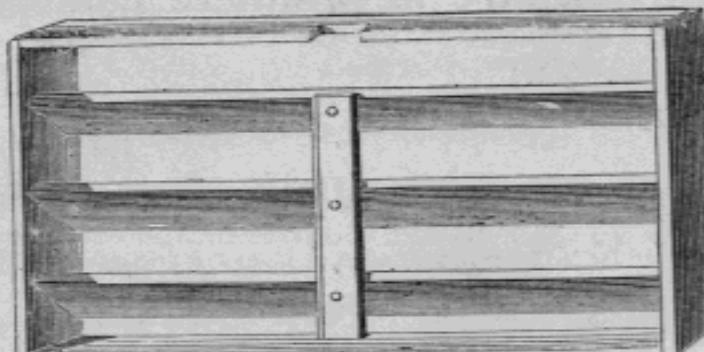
Persienne en bois de M. E. Damourette, vue ouverte.
